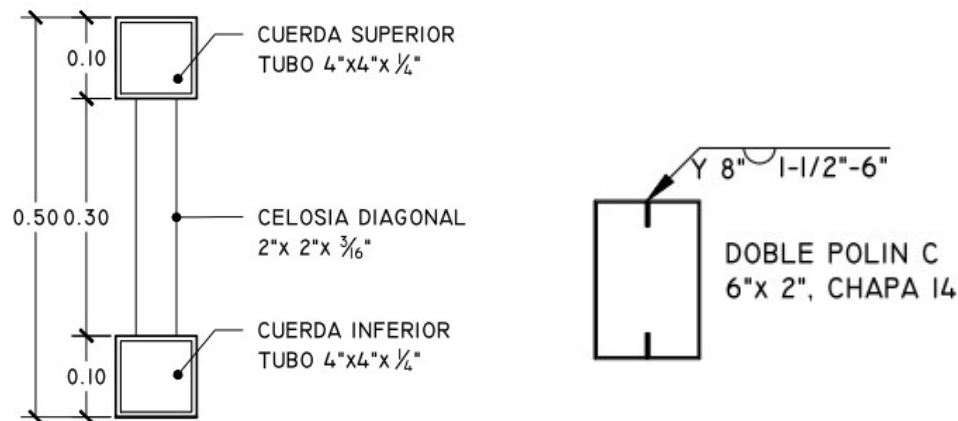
Detalles de Viga de Rigidez y Polín Encajuelado. Fuente: Elaboración Propia.
